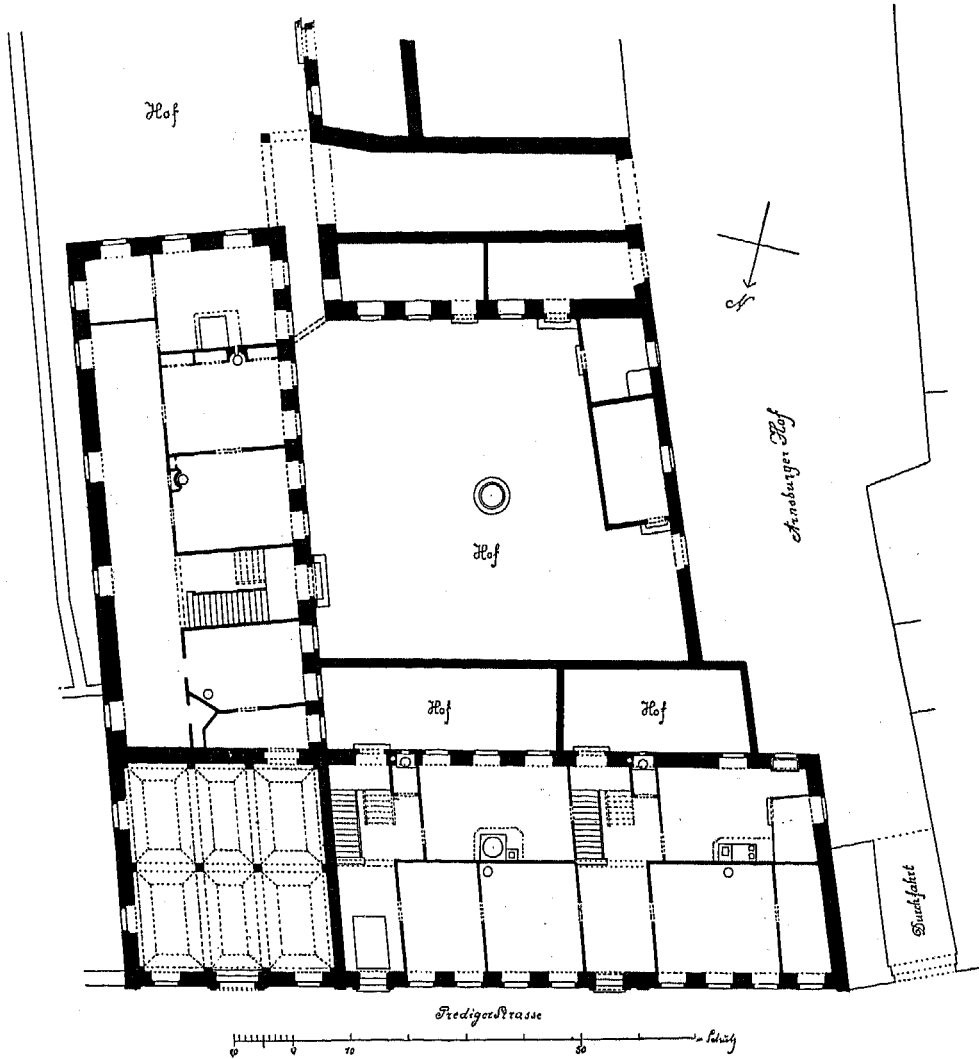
Arnsburger Hof; Grundriss des Hauptgebäudes, Prediger-Strasse Nr. 3 und 5. Nach einem unbezeichneten Plan vom Anfange des XIX. Jahrhunderts im Stadtarchiv. 1:400.
